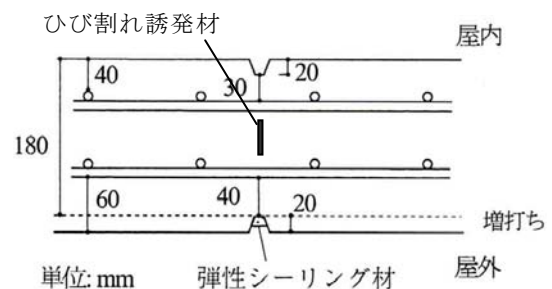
ひび割れ誘発材の設置例（例：平鋼）
